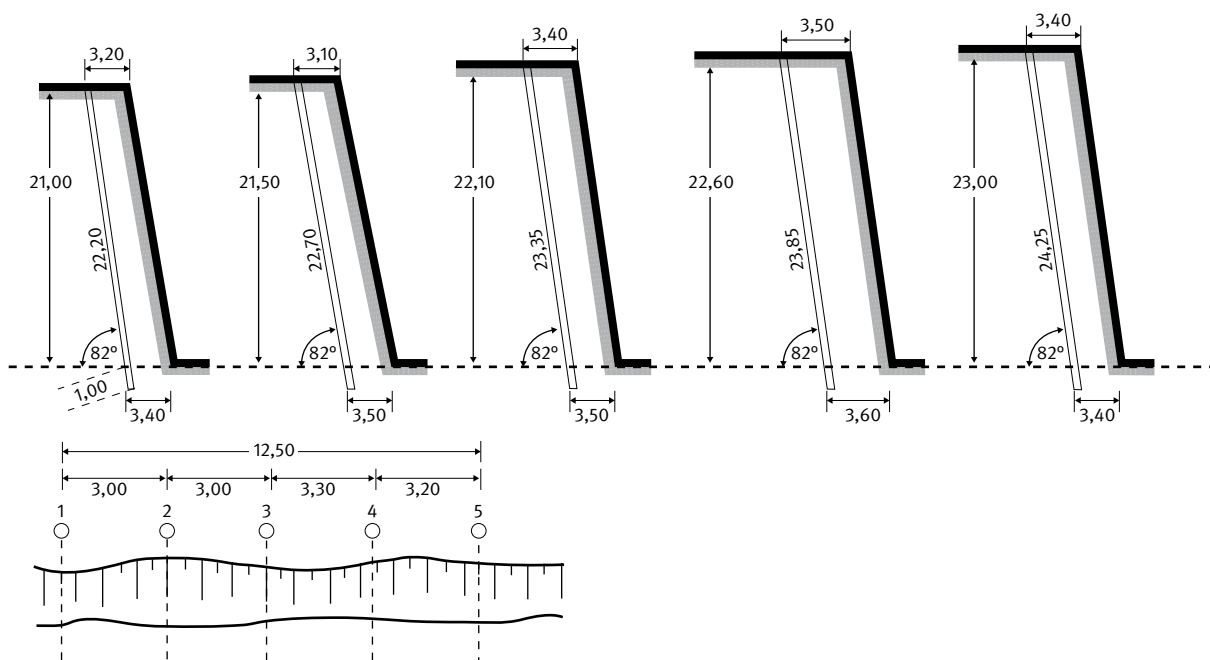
Profile und Grundriss zur Lademengenberechnung
